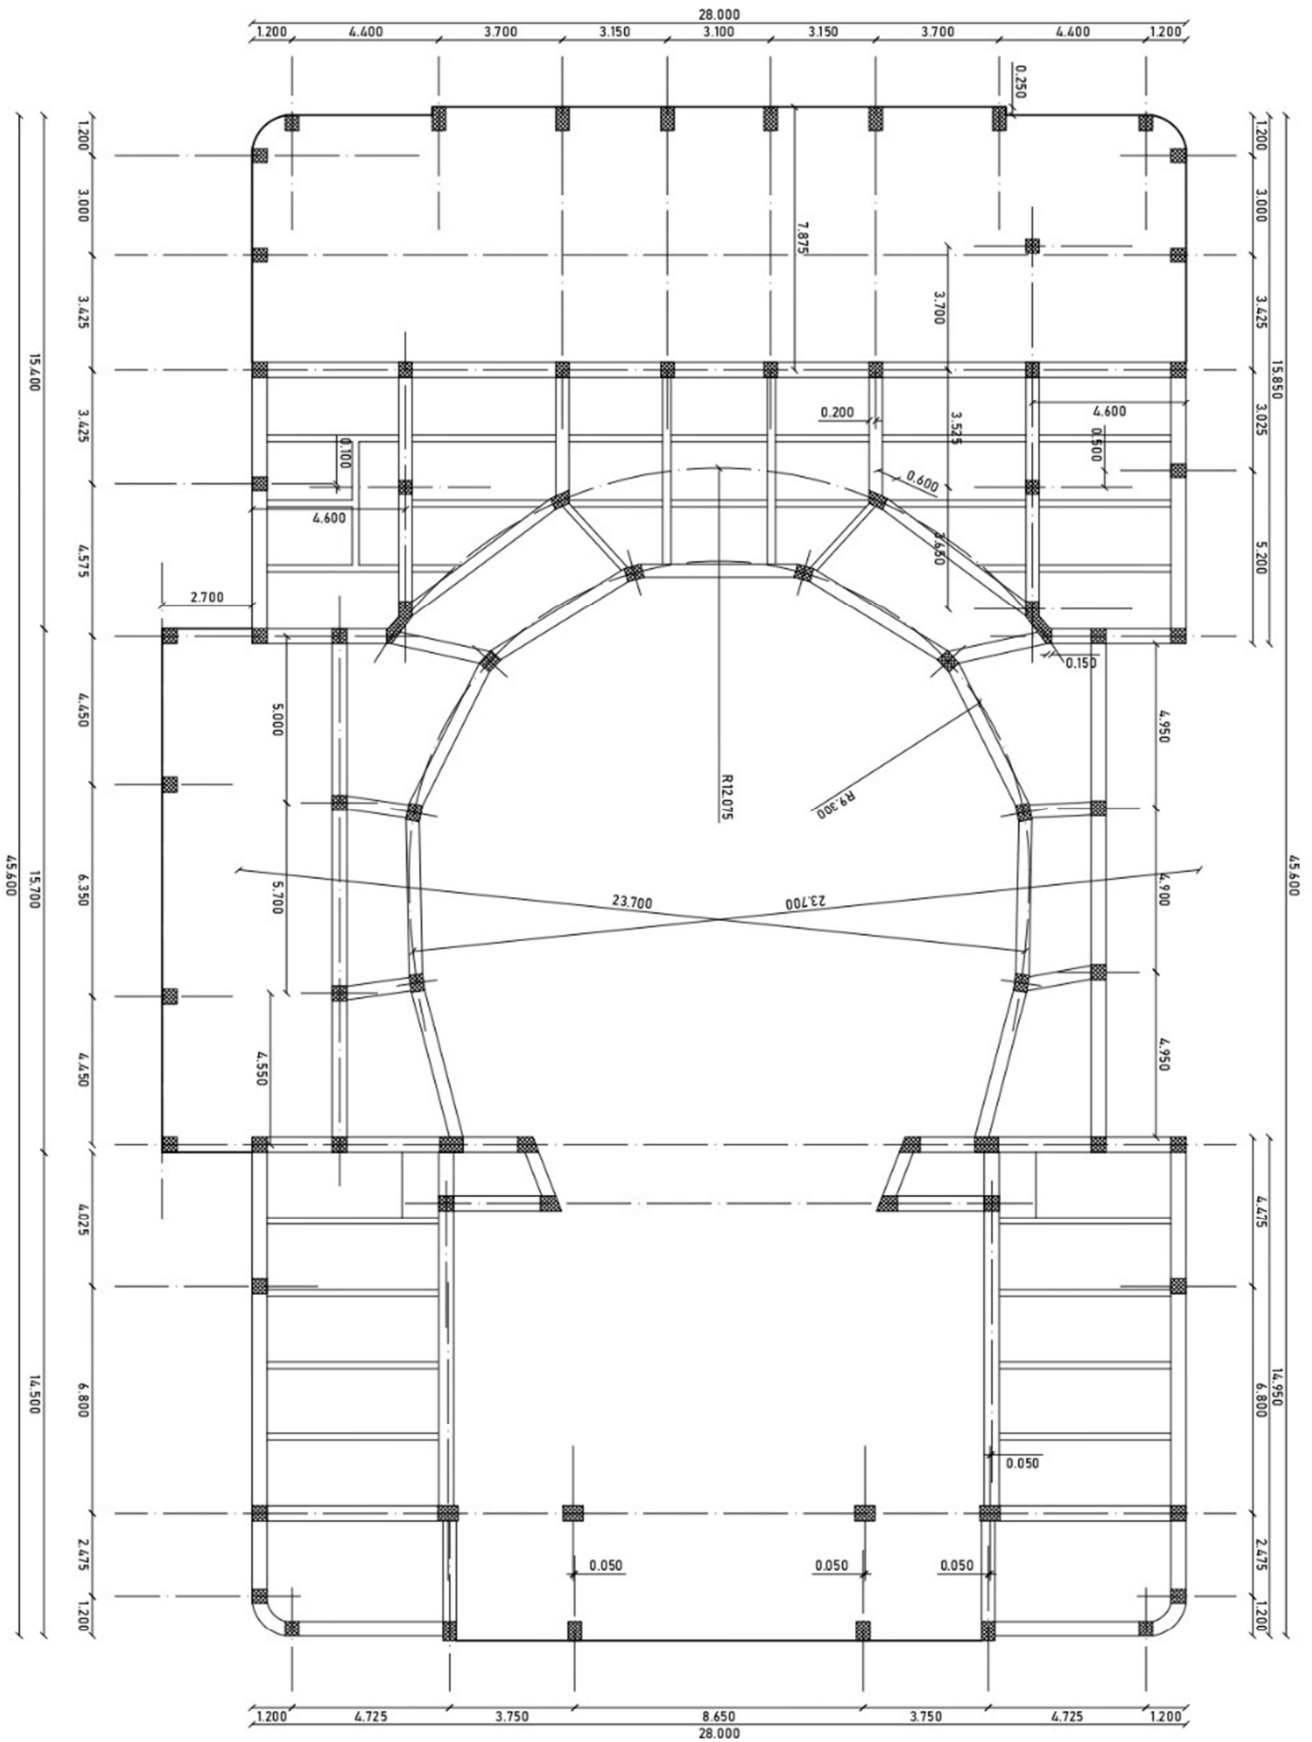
Pianta solaio piano platea su sotterraneo
